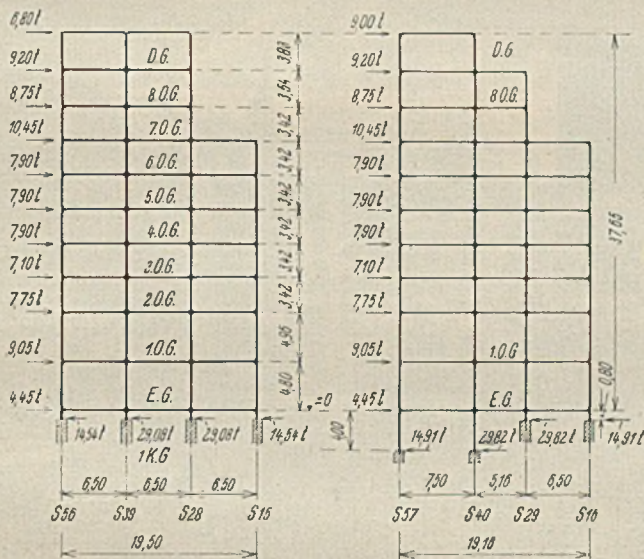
Belastungsschema der Stockwerkrahmen 56 ÷ 15 und 57 ÷ 16.
